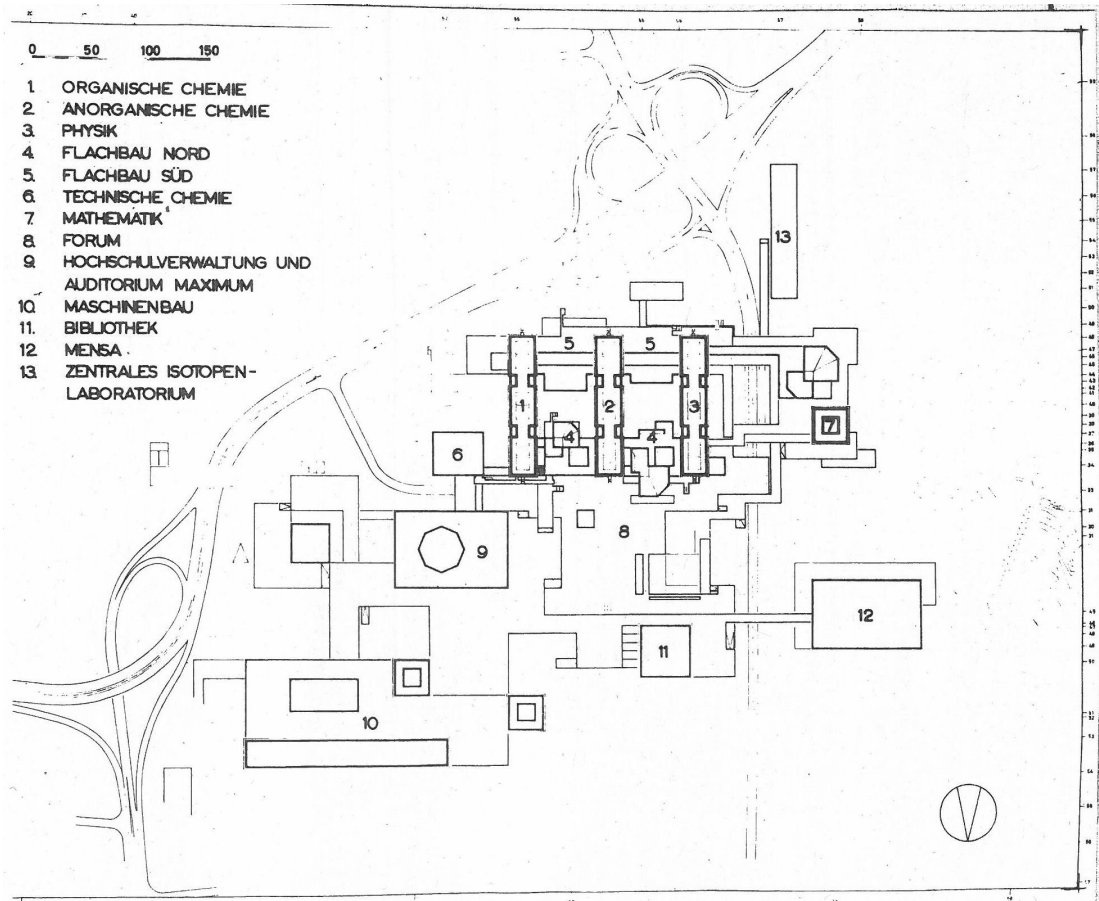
Campus in Stuttgart-Vaihingen, Lageplan aus dem Jahr 1967
